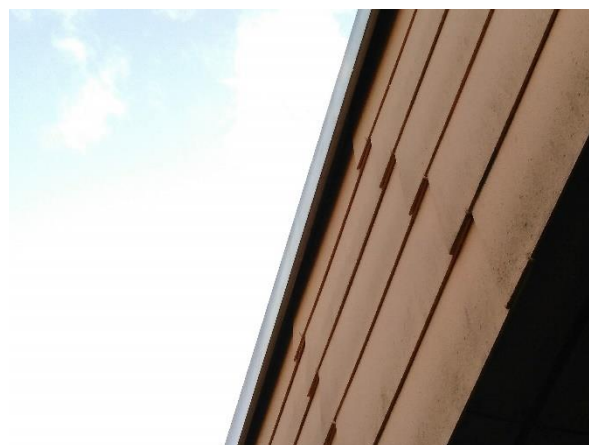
Spalt zwischen Dachverkleidung und Fassade
